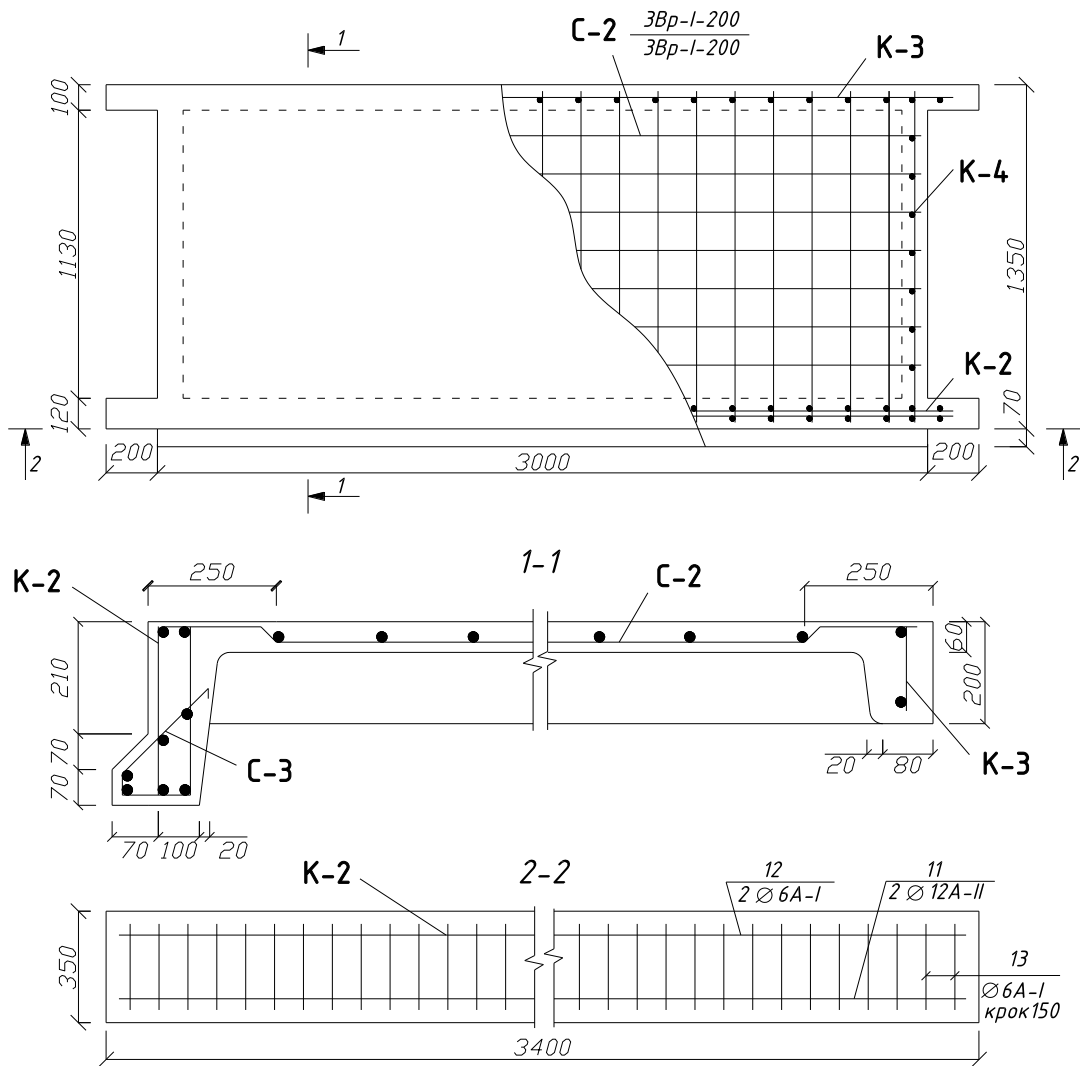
Опалубкове креслення та армування міжповерхової плити
